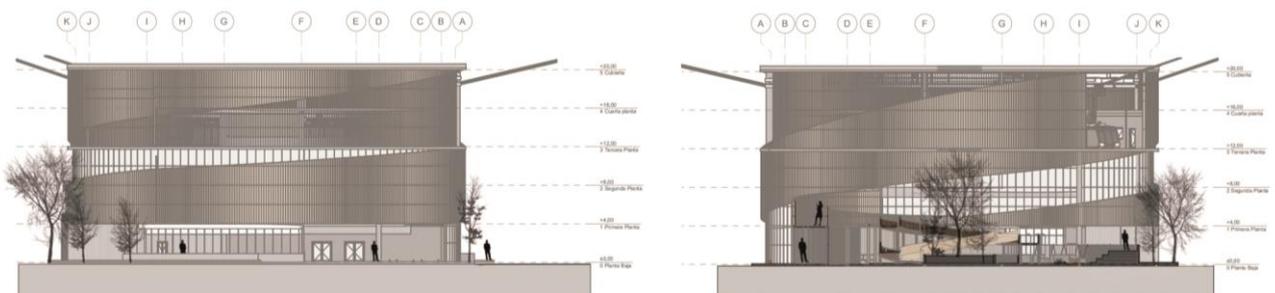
Fachada Norte y fachada Sur. Elaboración propia.
